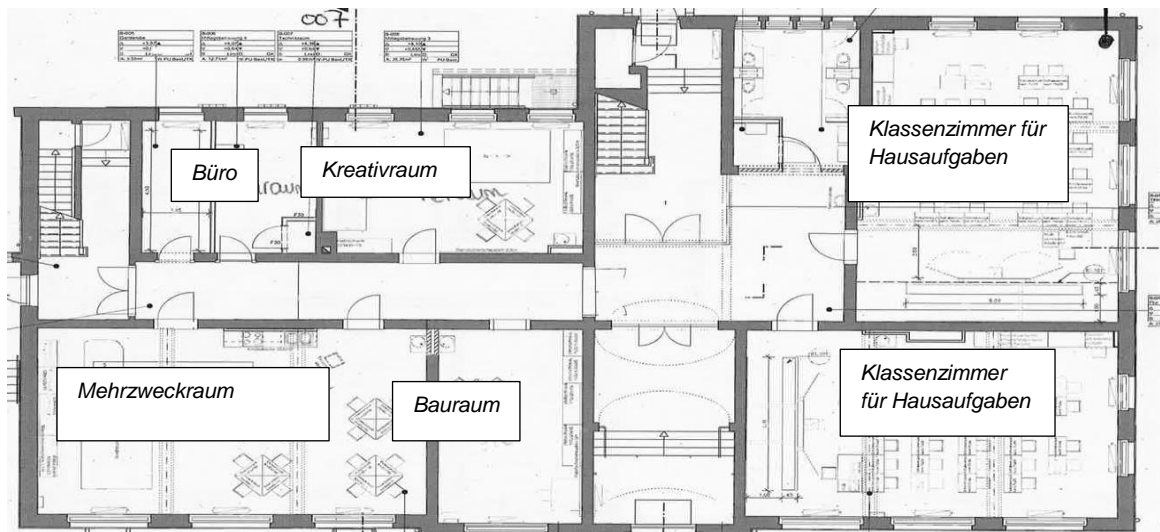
Grundriss Mädchenschulhaus
